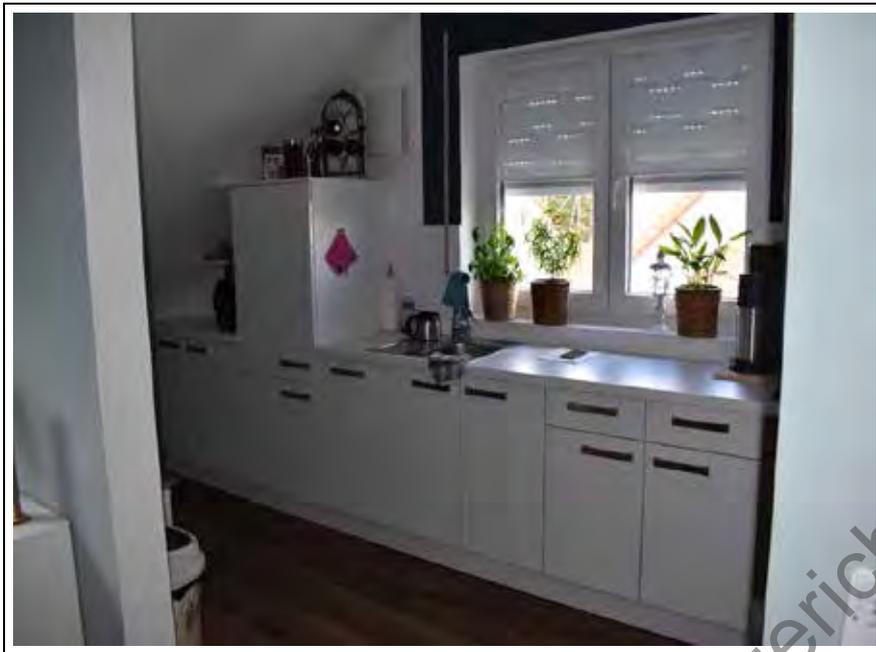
DG, Wohnung Nr. 7, Küche mit Einbauküche
